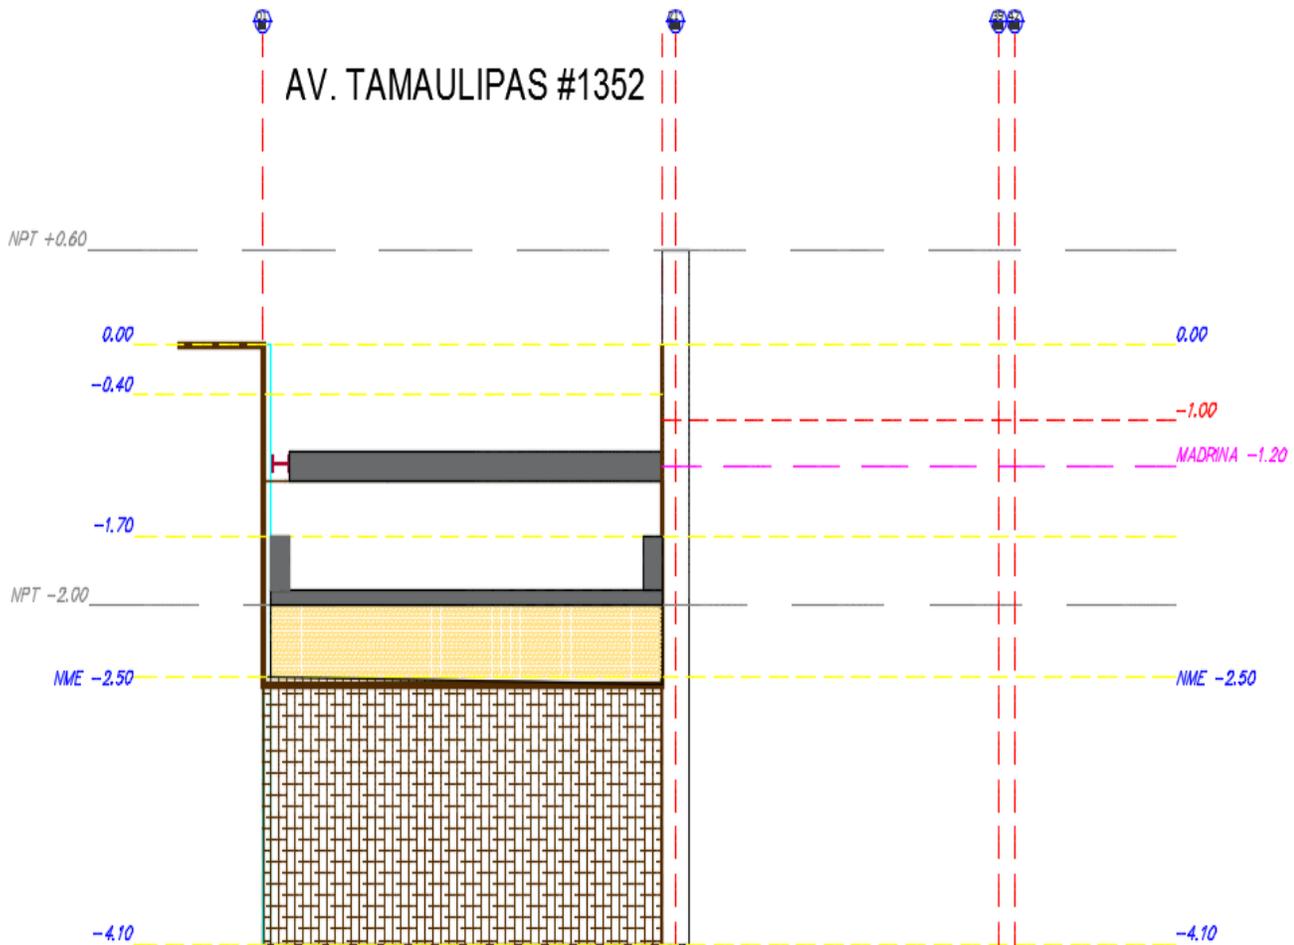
COLADO DE LOSA FONDO Y MUROS ESTRUCTURALES
